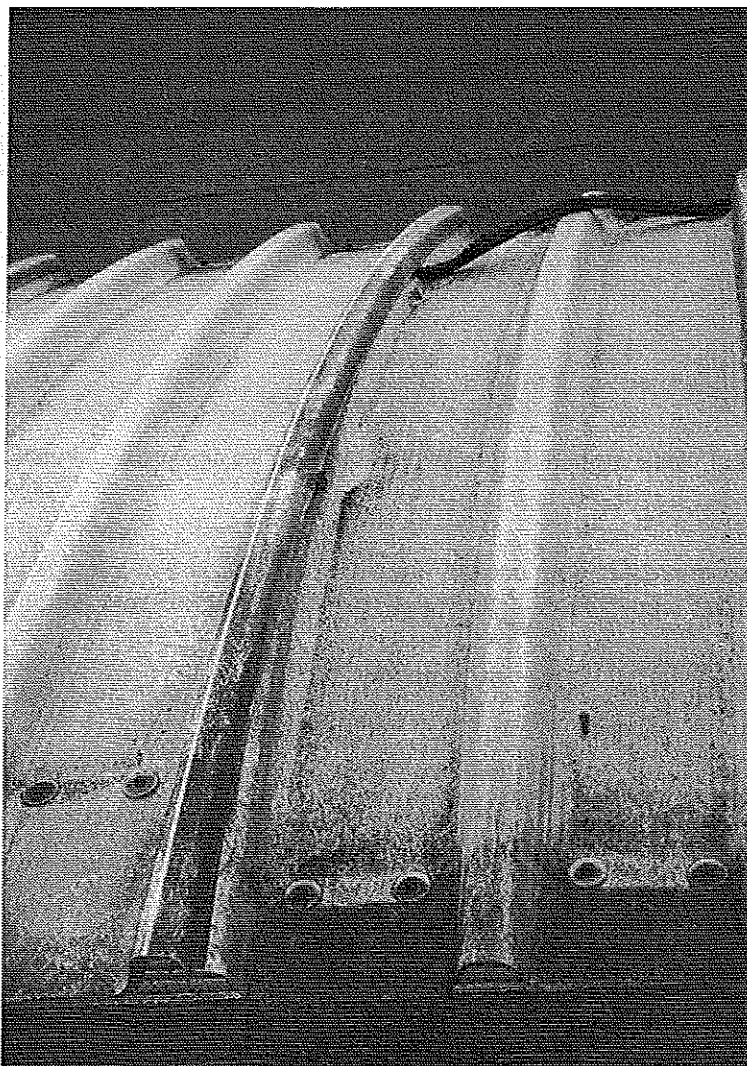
Garniture de joint de recouvrement de plaque sortie de l'emboîtement. © J. Putatti
